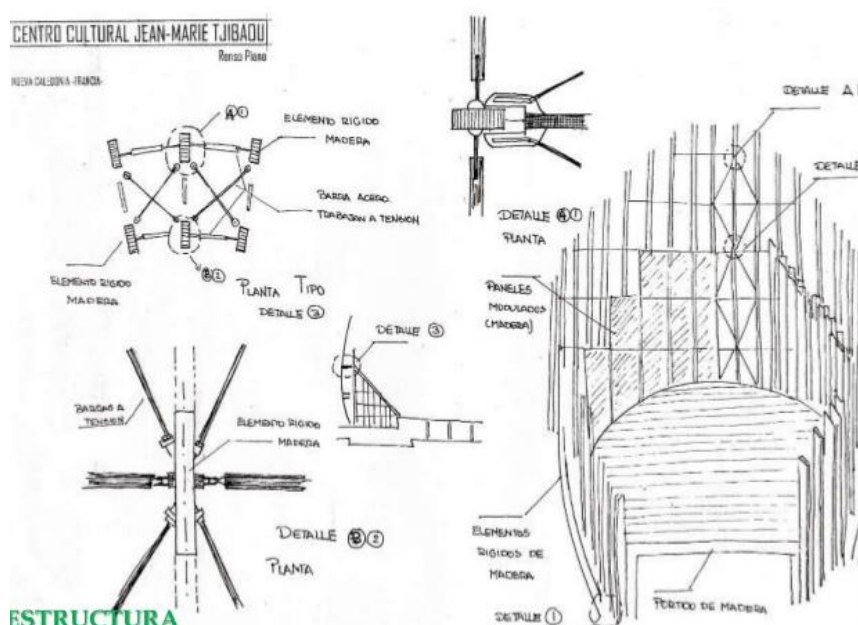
Eléments de construction: Poutres en acajou, ancrages en acier galvanisé et lattes en Iroko.
